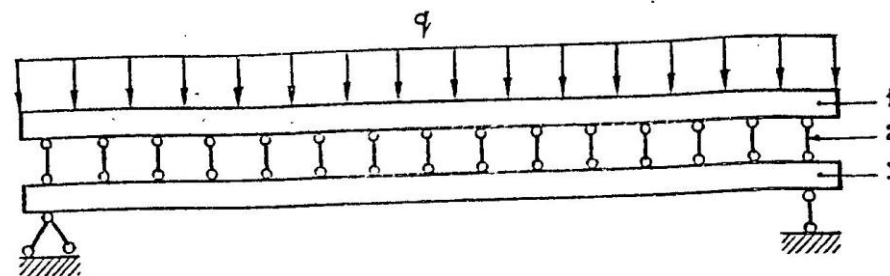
Расчетная схема системы «Усиливаемая балка-элемент усиления».
